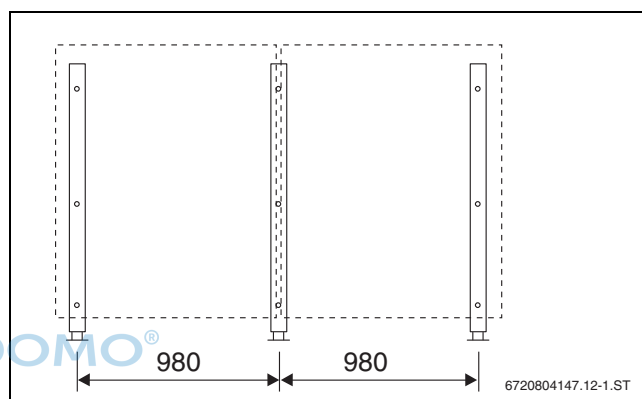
Grundauführung, 2 senkrechte Kollektoren (Maße in mm)
